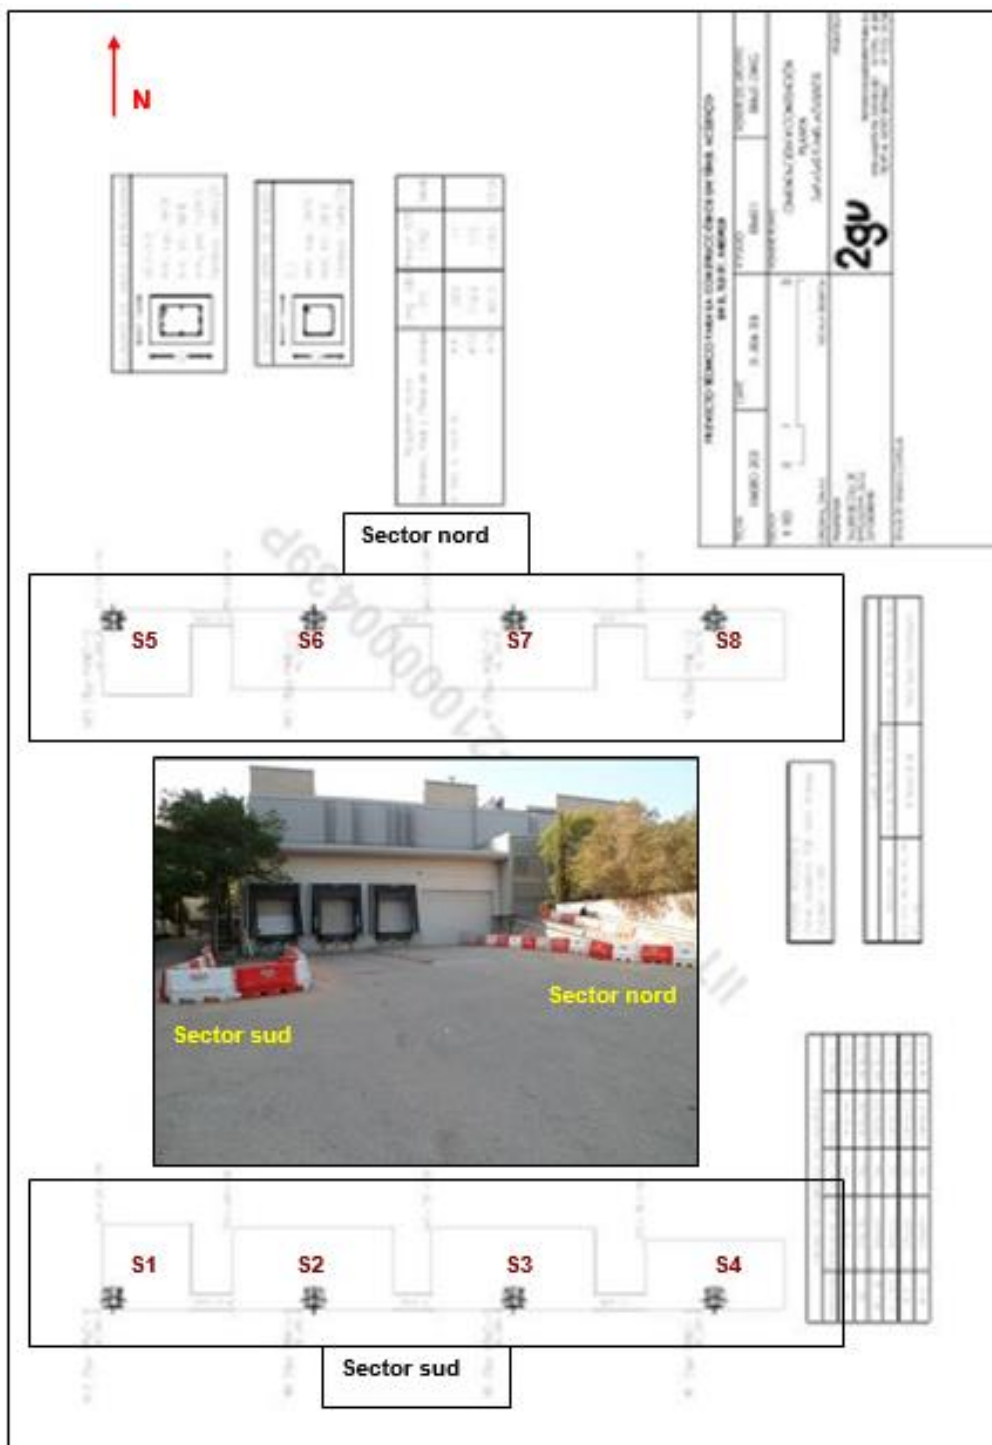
Detall de la situació de les sabates de fonamentació per la construcció del túnel del mur acústic. Font: PIA- Proyecto para la construcción de un túnel acústico en el TEB de Sant Andreu- Carles Navarro (2021).
